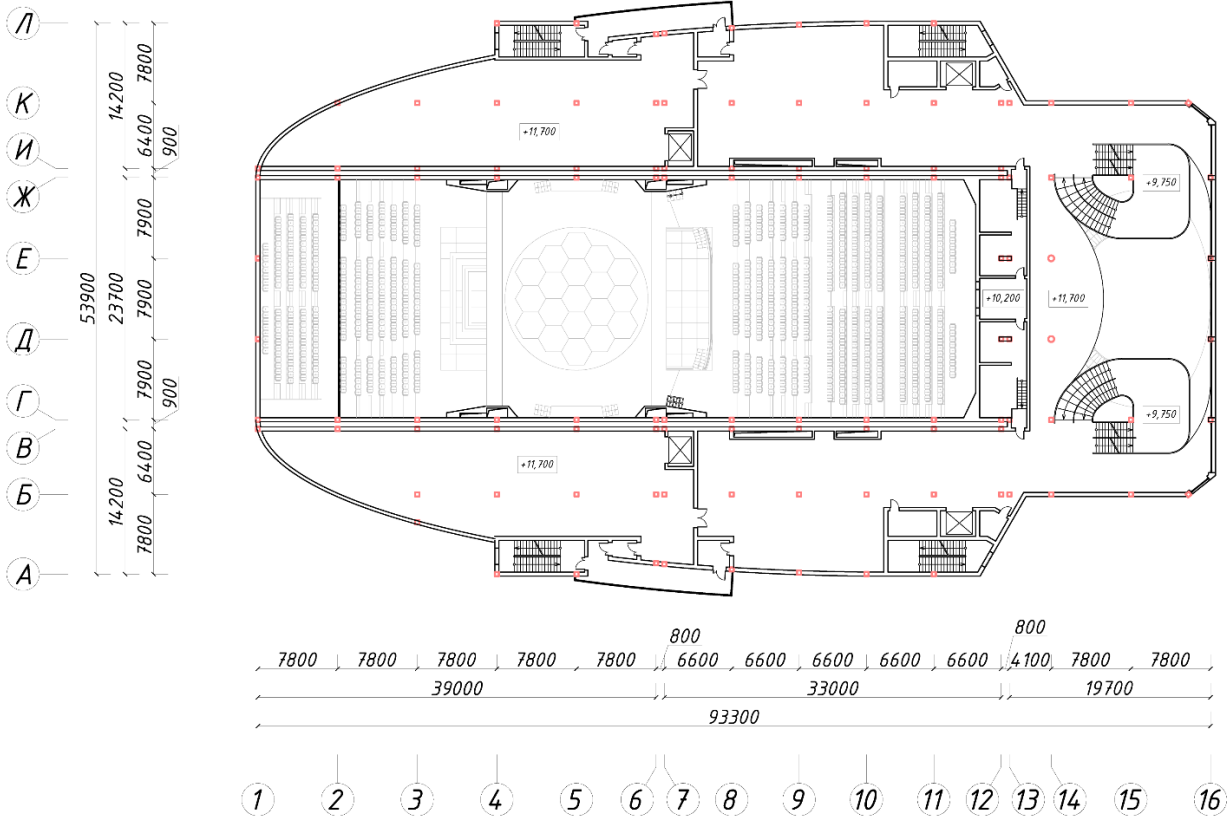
Схема плану поверху на позначці +11.700.
